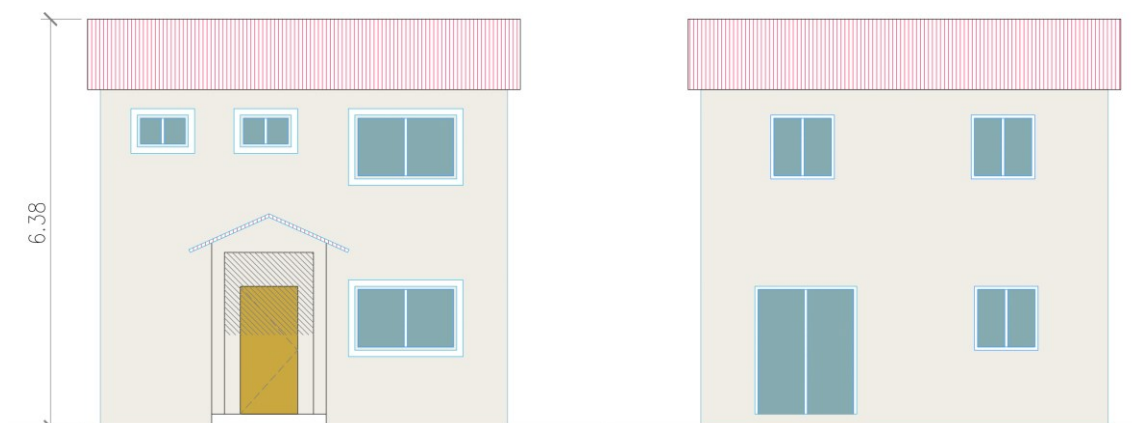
Fachada Frontal y Fachada Posterior (antes de la remodelación)
